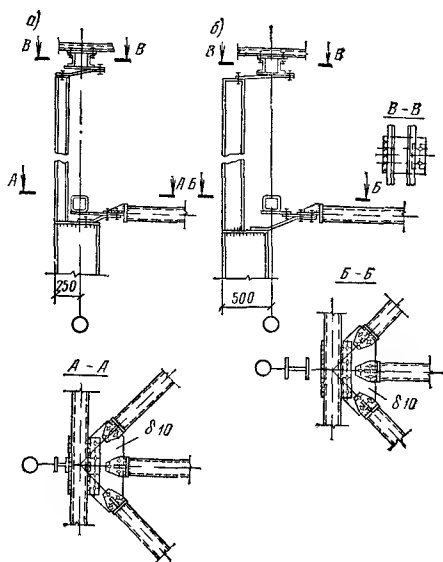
Деталь крепления стоек фахверка к покрытию со стропильными фермами из прямоугольных труб
